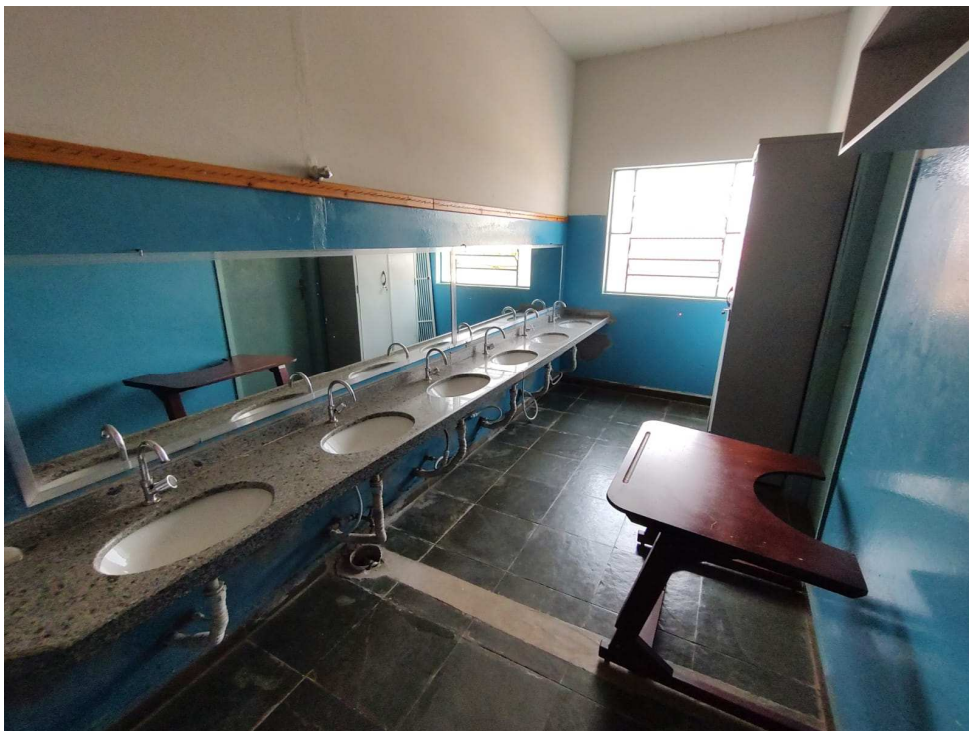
(Escovodromo onde será colocado piso e forro de gesso);
